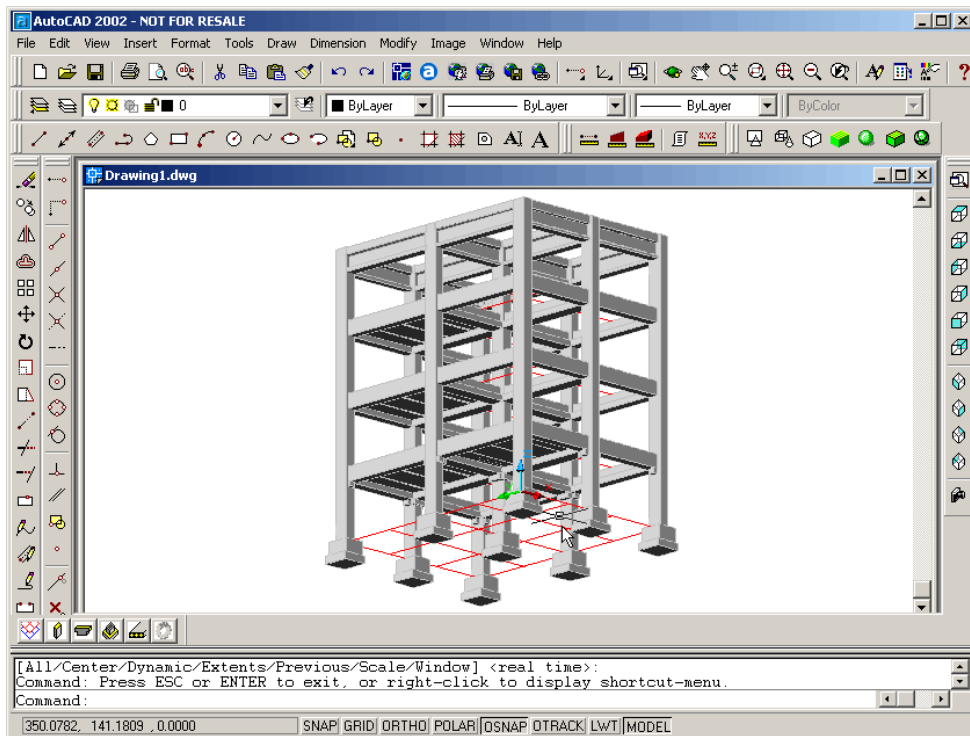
Outro ângulo de visão da estrutura da FIG. 5.14.
